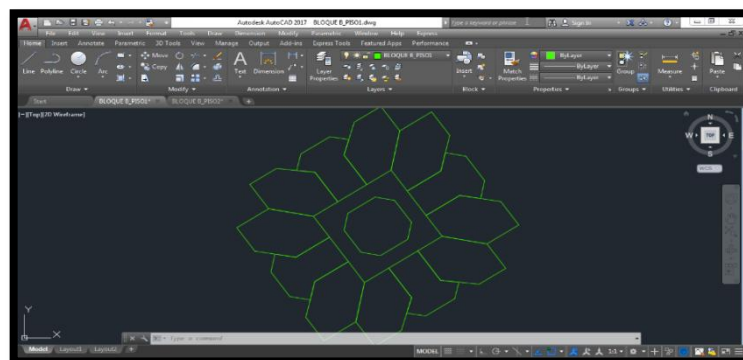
Levantamiento en AutoCAD del piso 1, Bloque B
